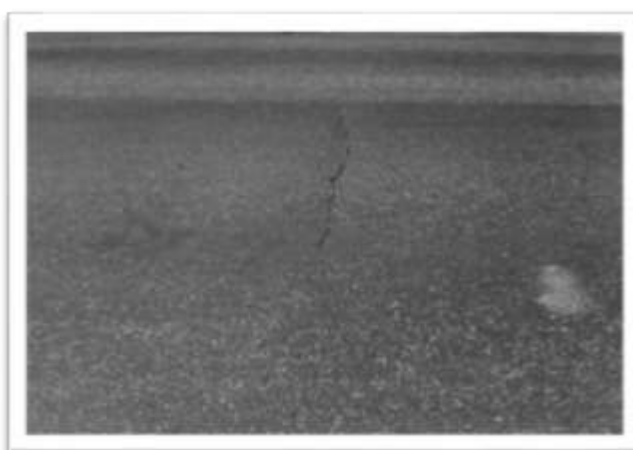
Grietas longitudinales y transversales, severidad baja
